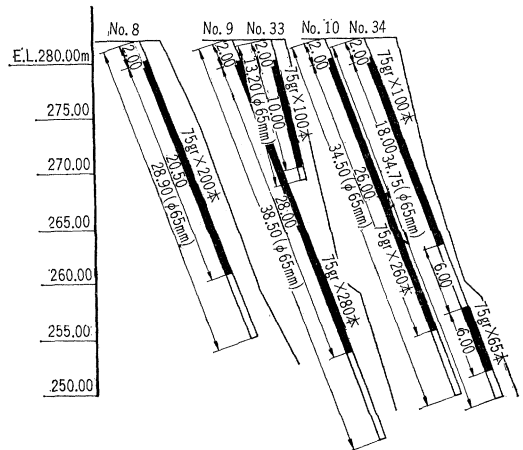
(b) 鳴子ダム長孔発破掘削せん孔位置平面図
